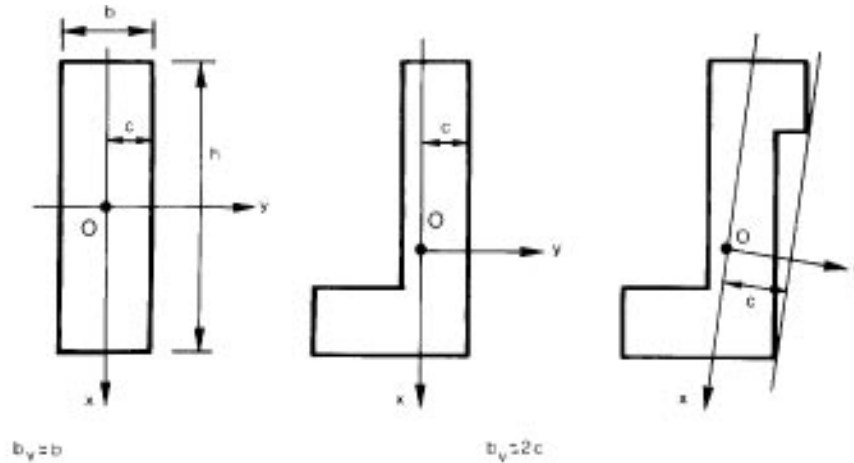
ANCHURA VIRTUAL DE LA SECCIÓN DE UN ELEMENTO DE HORMIGÓN EN MASA
